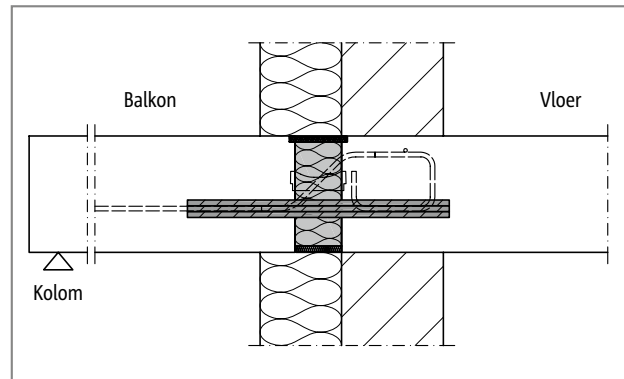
Schöck Isokorb® T type H: Vrij uitkragend balkon
